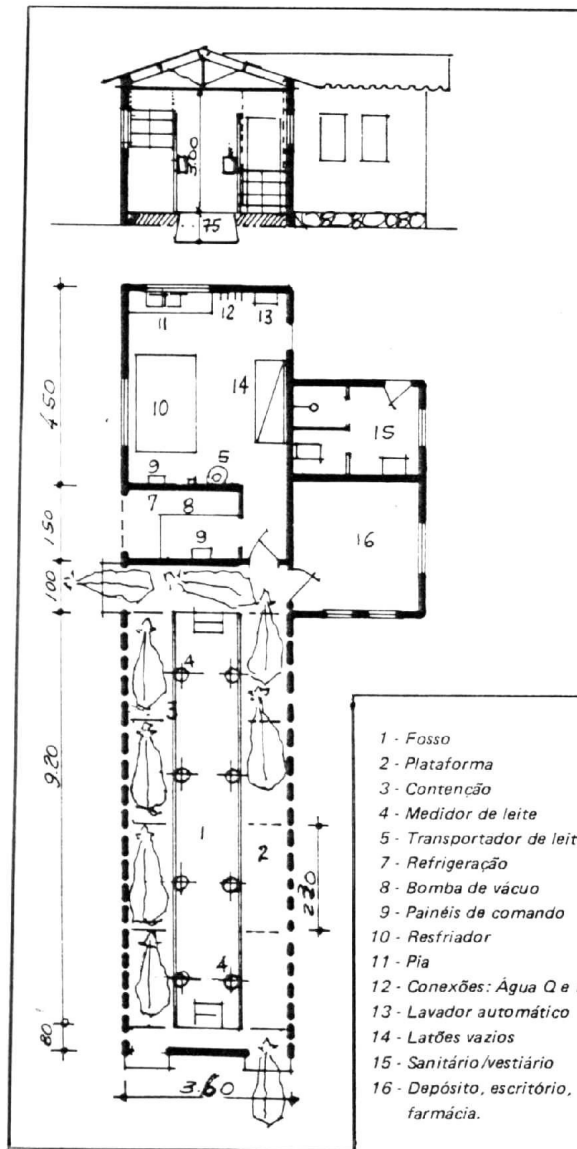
Corte vertical transversal e planta baixa de estábulo com sala de leite modelo (M-8) (Sala de ordenha "Walk-through" 2 x 4 em linha reta).
